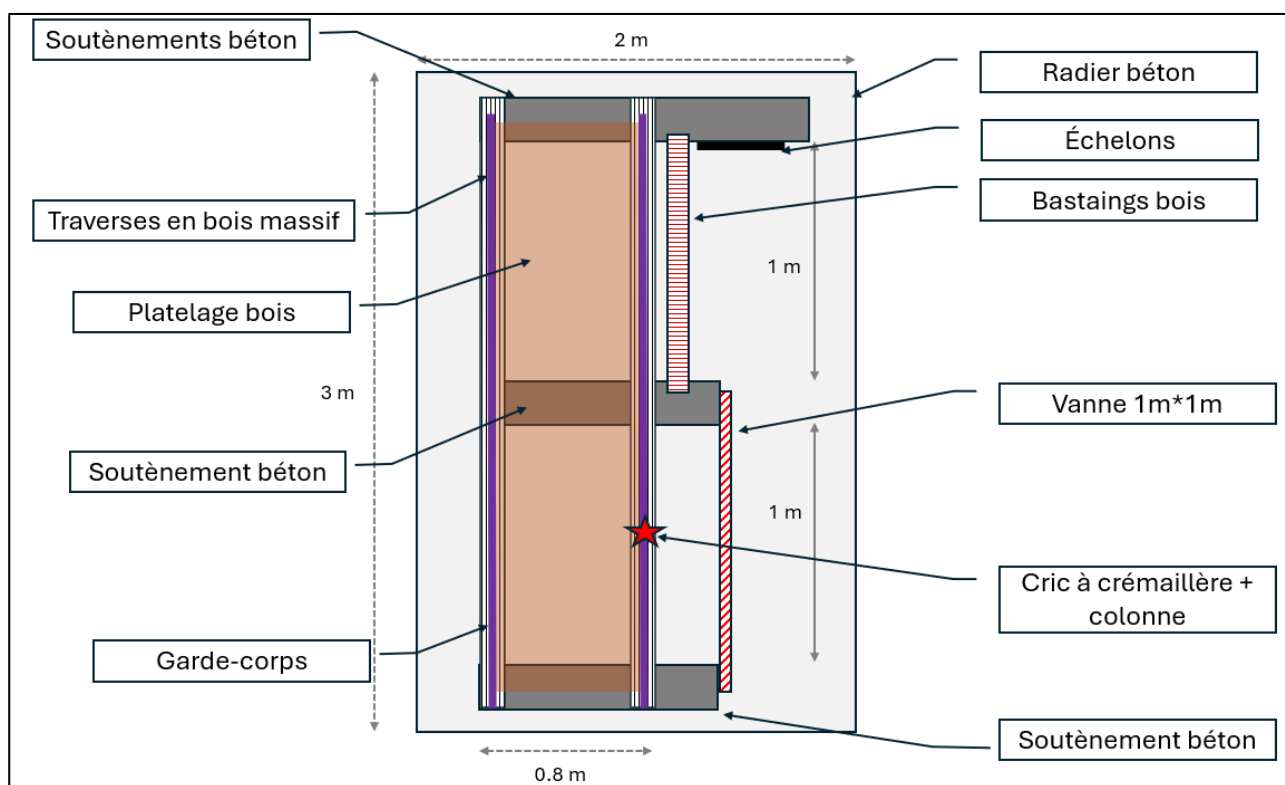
Vue en plan de principe des ouvrages n°202 et n°203
